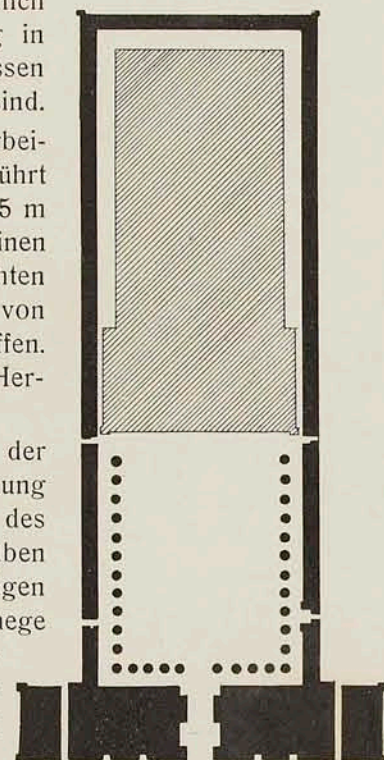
Grundrißschema des Tempels in Edfu (nach Bädcker).
